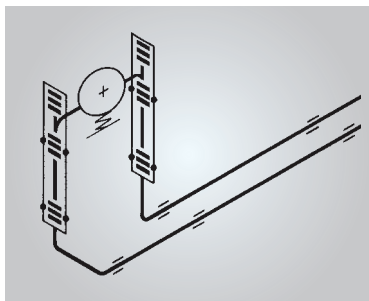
Eckentlastete Kompensatoren als Pumpenanschlüsse
